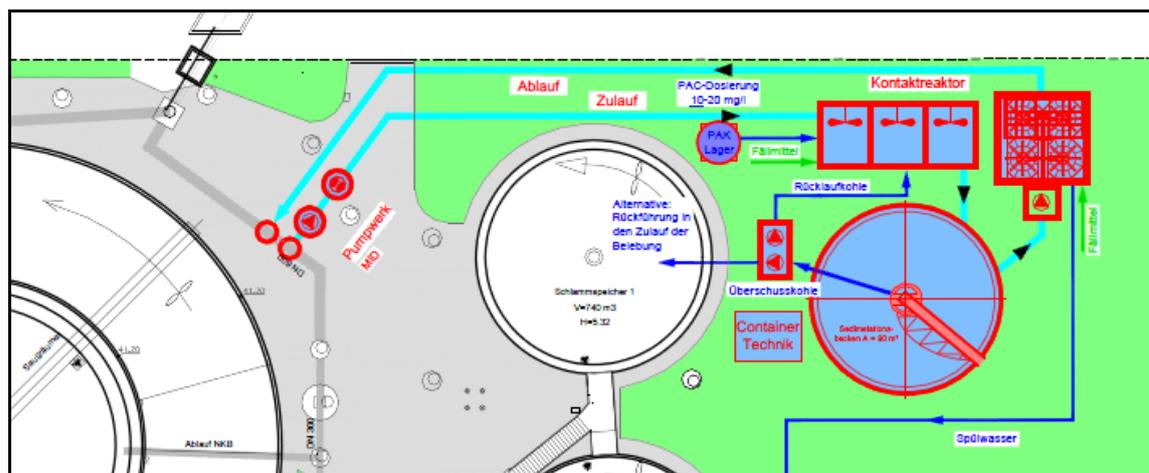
Lageplan KA Rahden - Variante 1.2 – PAK Dosierung in adsorptive Reinigungsstufe
